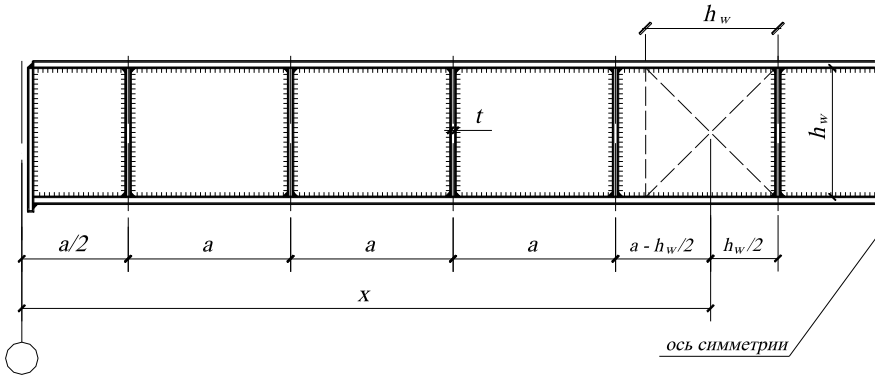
Схема для определения расстояний до наиболее напряженного сечения стенки главной балки
